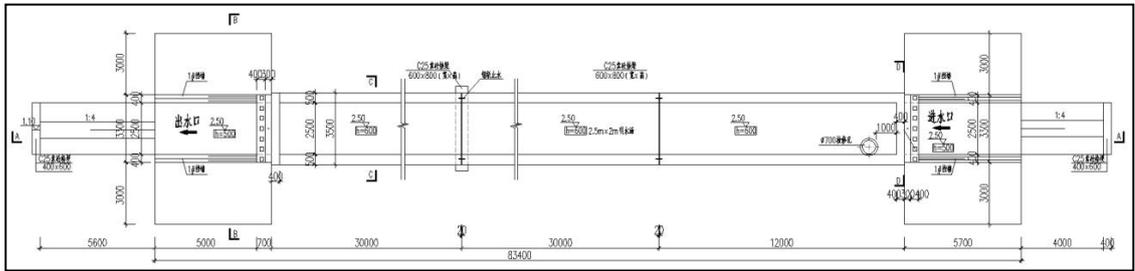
连通涵闸（赵家闸泵站位置）平面图
